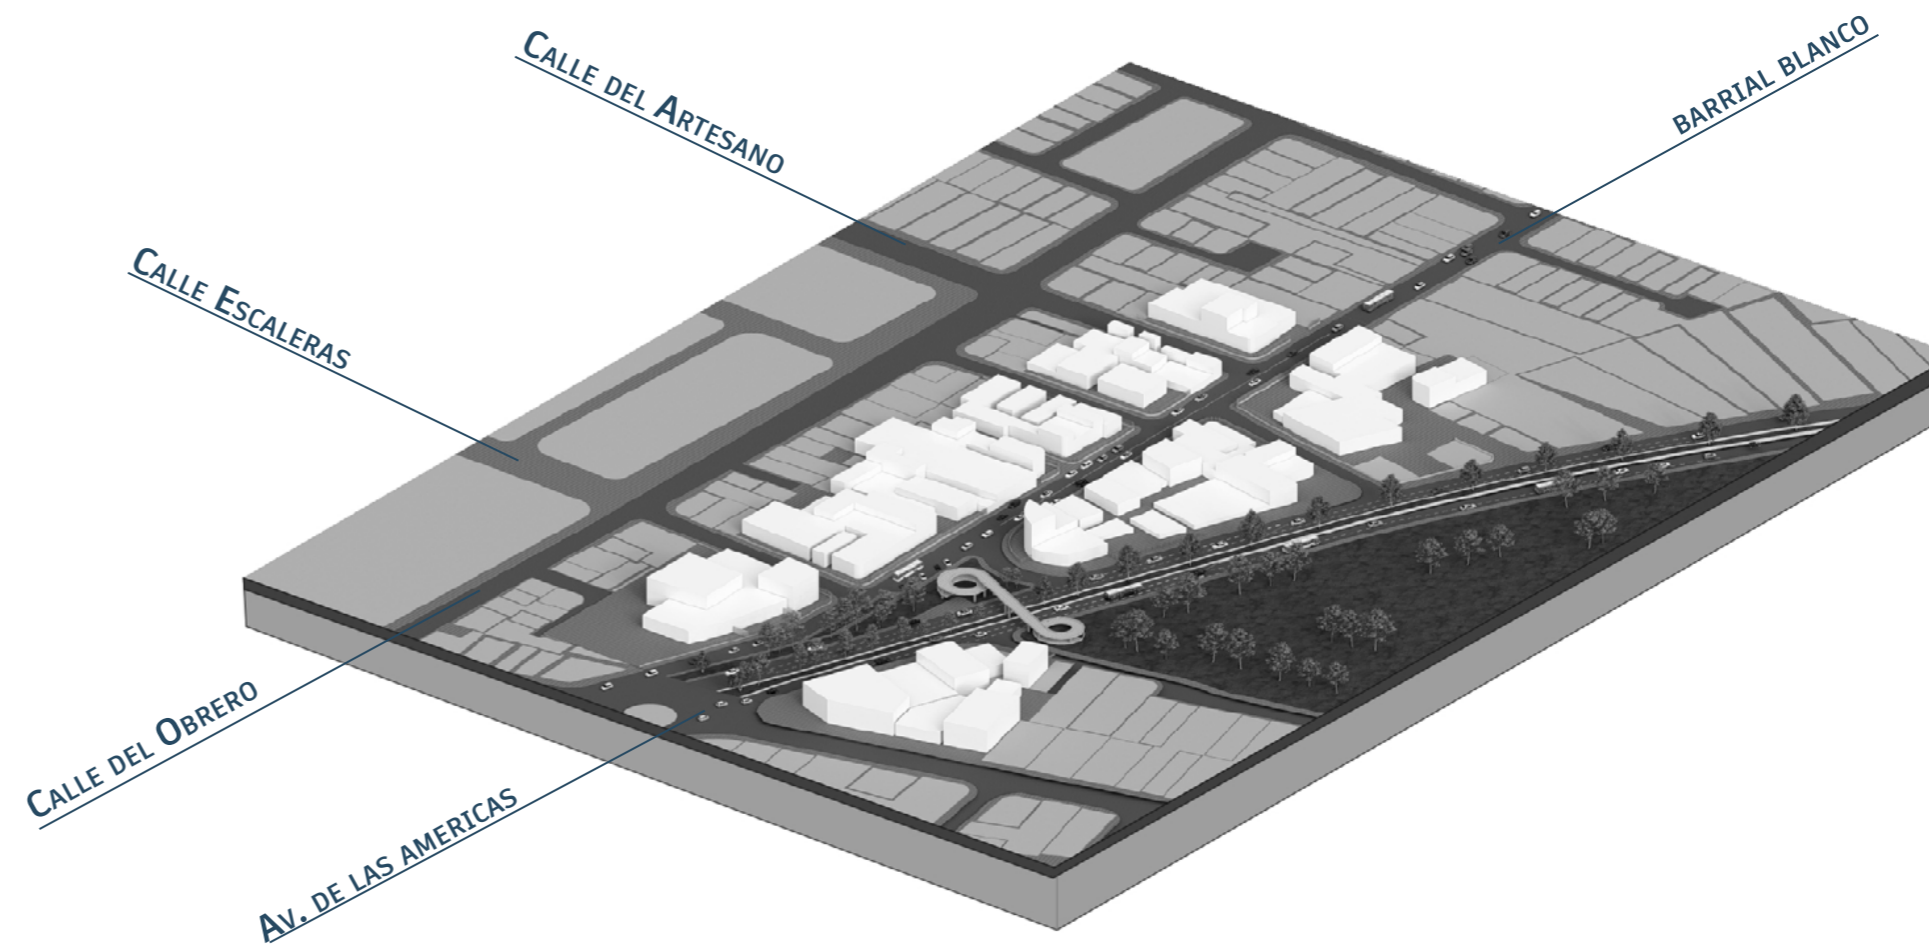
Axonometría estado actual, calle Barrial Blanco, encuentro con Av. Las Americas. Fuente propia
